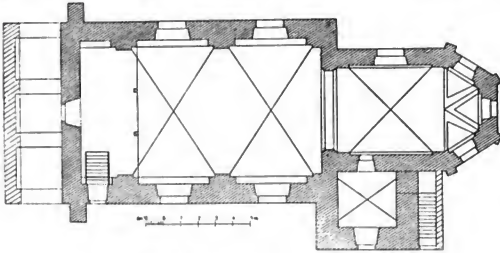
Meschno. Grundriss der Kirche.
